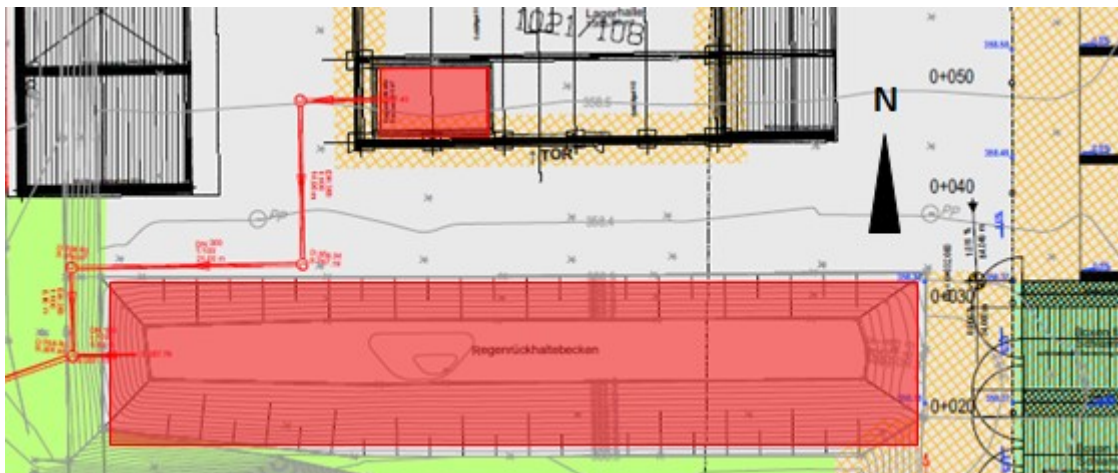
Lageplan der Entwässerungseinrichtungen der Lagerfläche (vergrößert)
